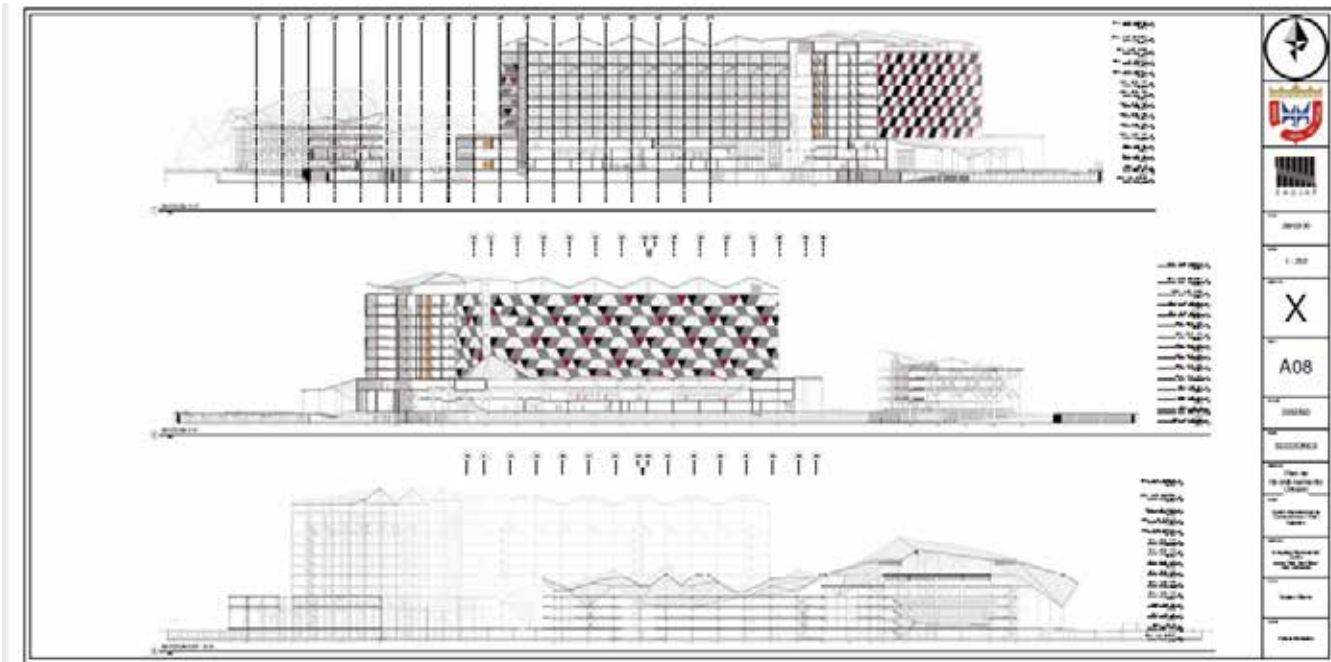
Secciones Longitudinales CICV. Fuente: Violeta Monsalve
